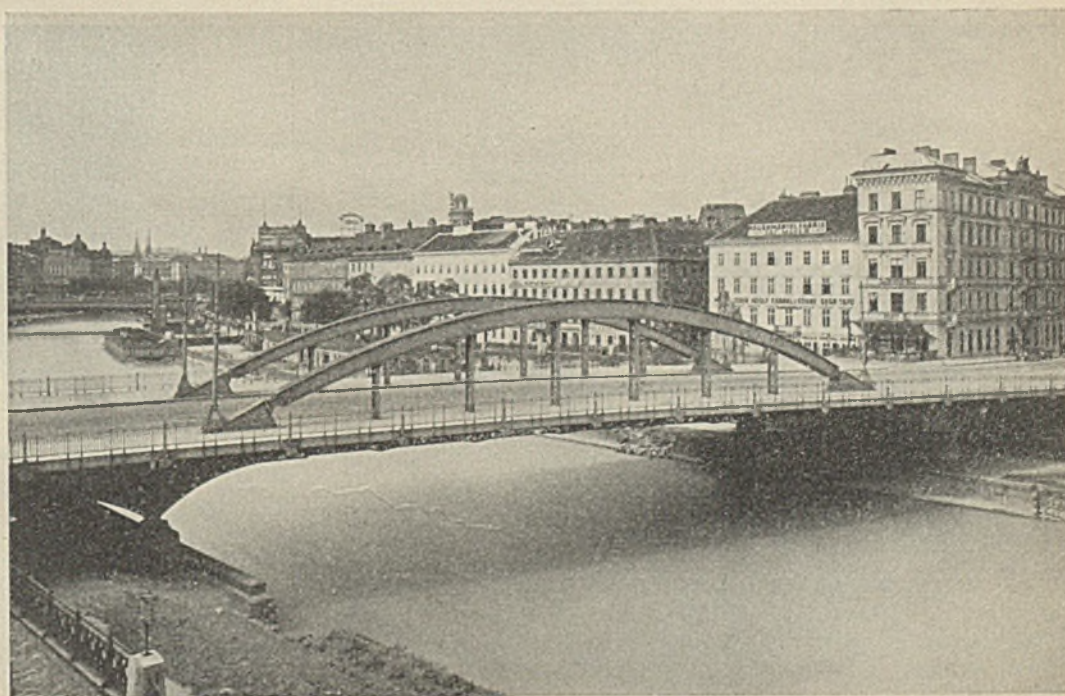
Aspern-Straßenbrücke über den oberen Donaukanal in Wien.
